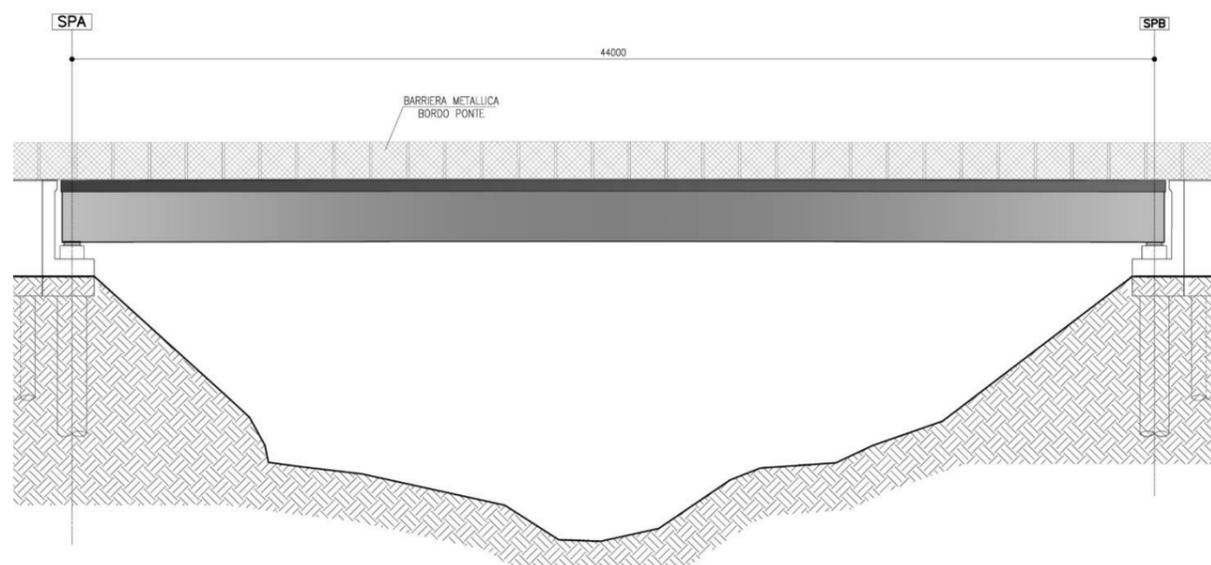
prospetto di progetto ponte sul fiume Savena³⁴
